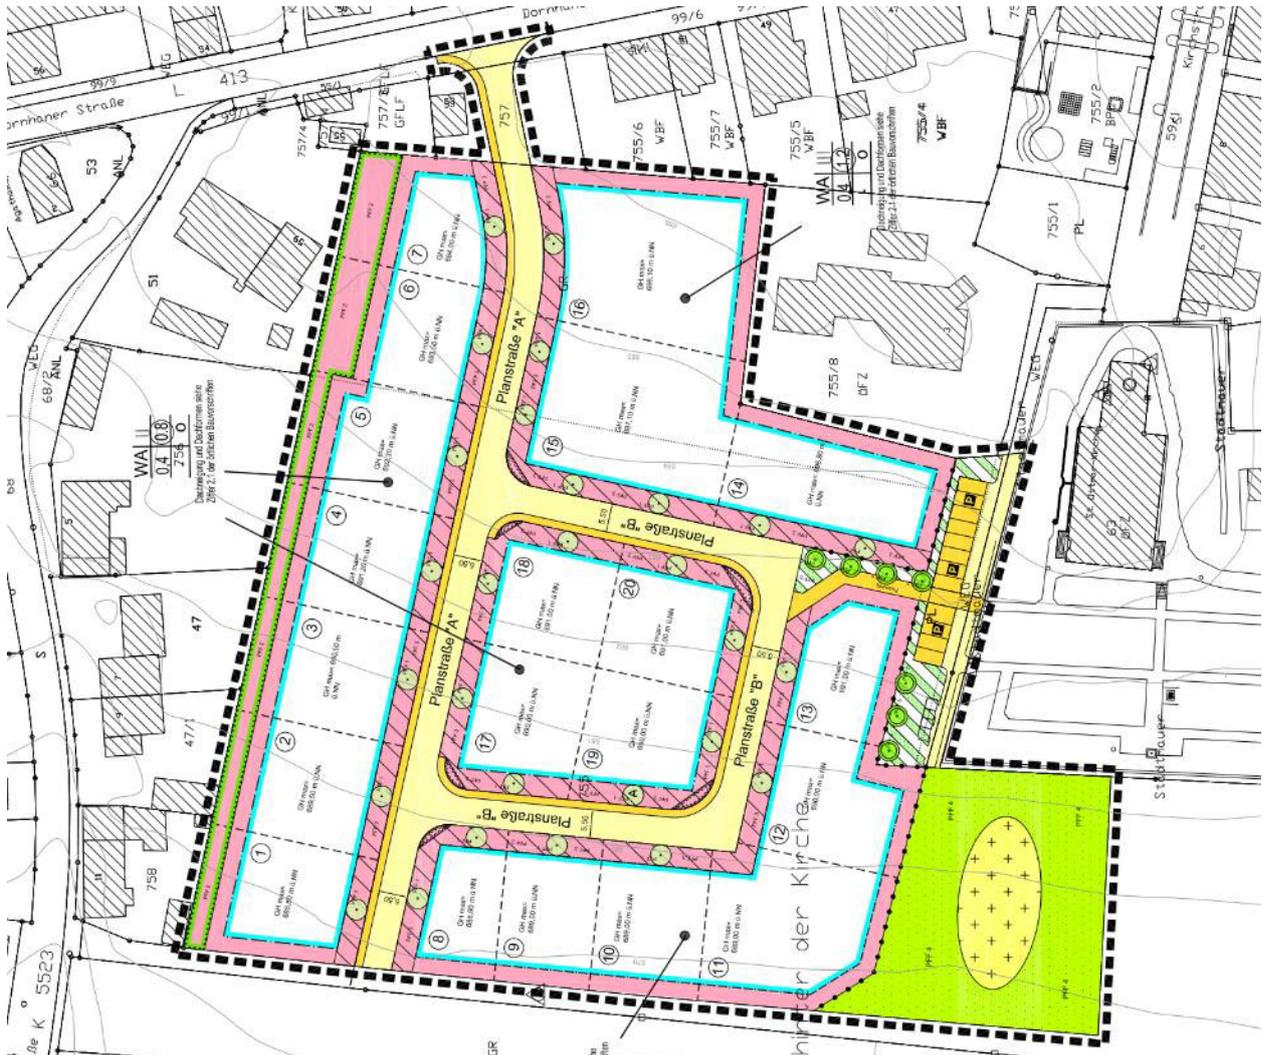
B-Plan „Hinter der Kirche“ (Rottweiler Ing.- und Planungsbüro GmbH, 13.06.2024)
